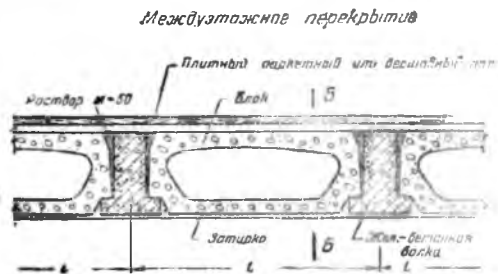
Перекрытие с несущими шлакобетонными плитами
